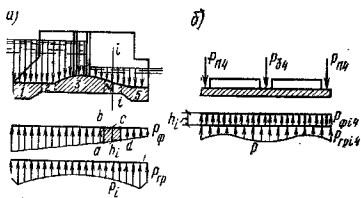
Схемы к расчету прочности фундаментной плиты с низким водосливным порогом в продольном направлении
